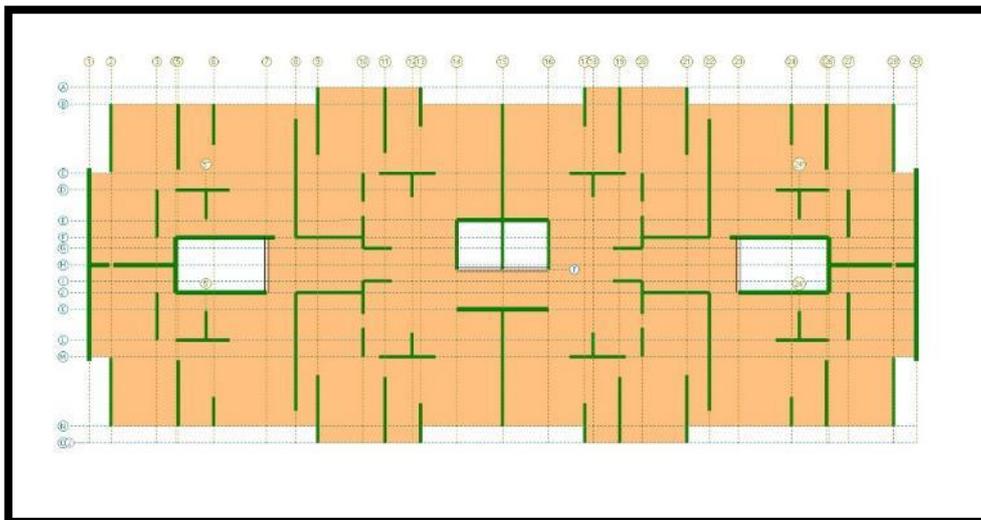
Planta Piso Tipo Altagracia. (Autor, 2018)
